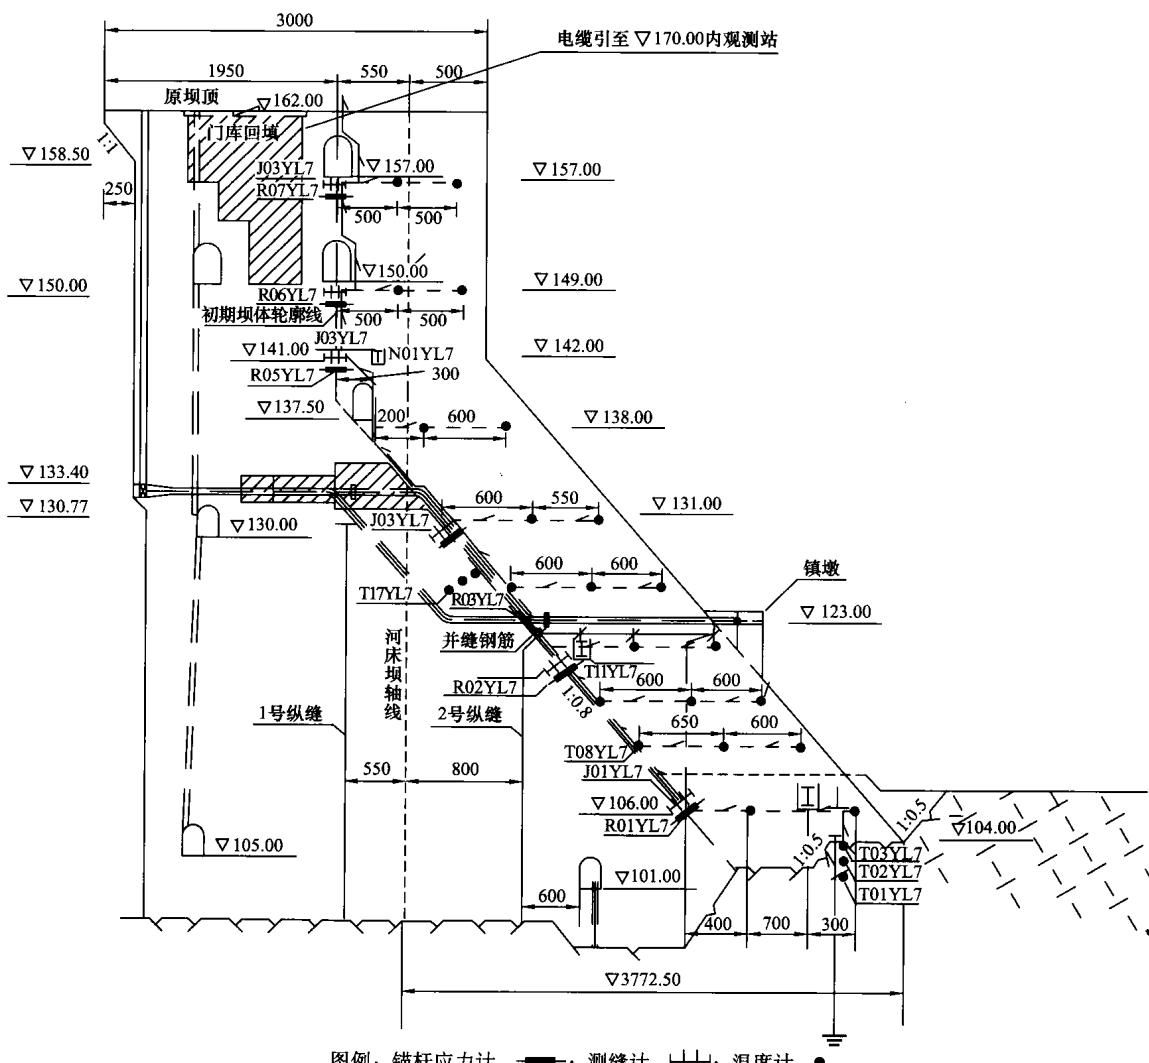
右联 7 号坝段高程 162m 以下监测仪器布置示意图（高程单位：m，尺寸单位：cm）
